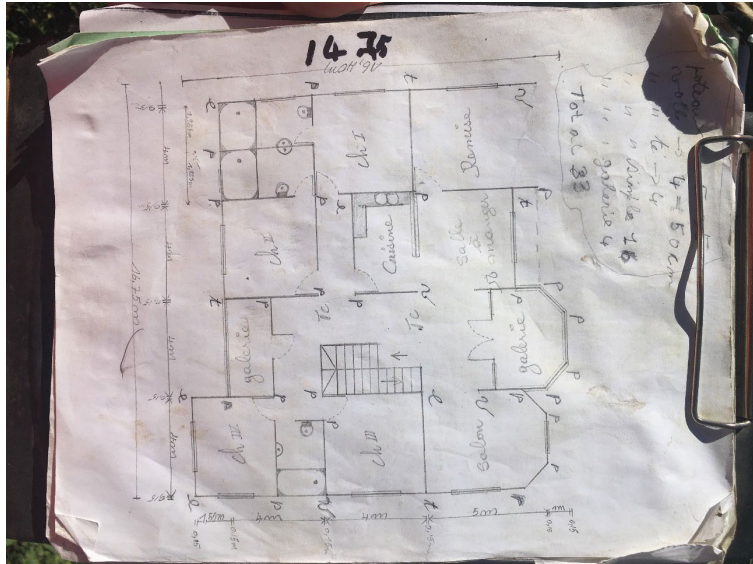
Plan de distribution/Floor plan for Chantye Divizyon (Bos Thomas, 2018)
